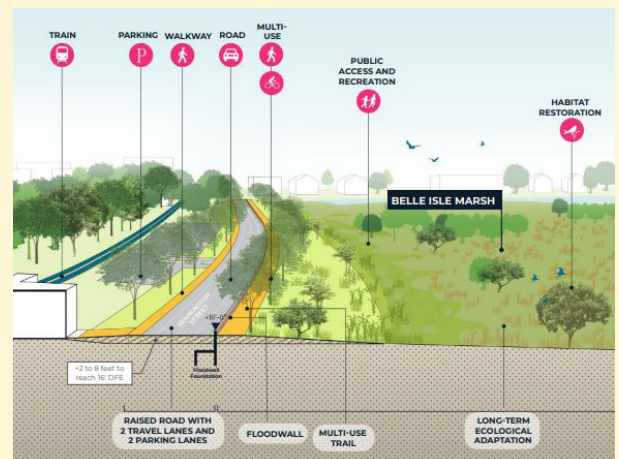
TRAMO PLANIFICADO DEL PILOTO DE MEJORAS DE SEGURIDAD DE BENNINGTON STREET A LO LARGO DE BELLE ISLE MARSH EN EAST BOSTON
